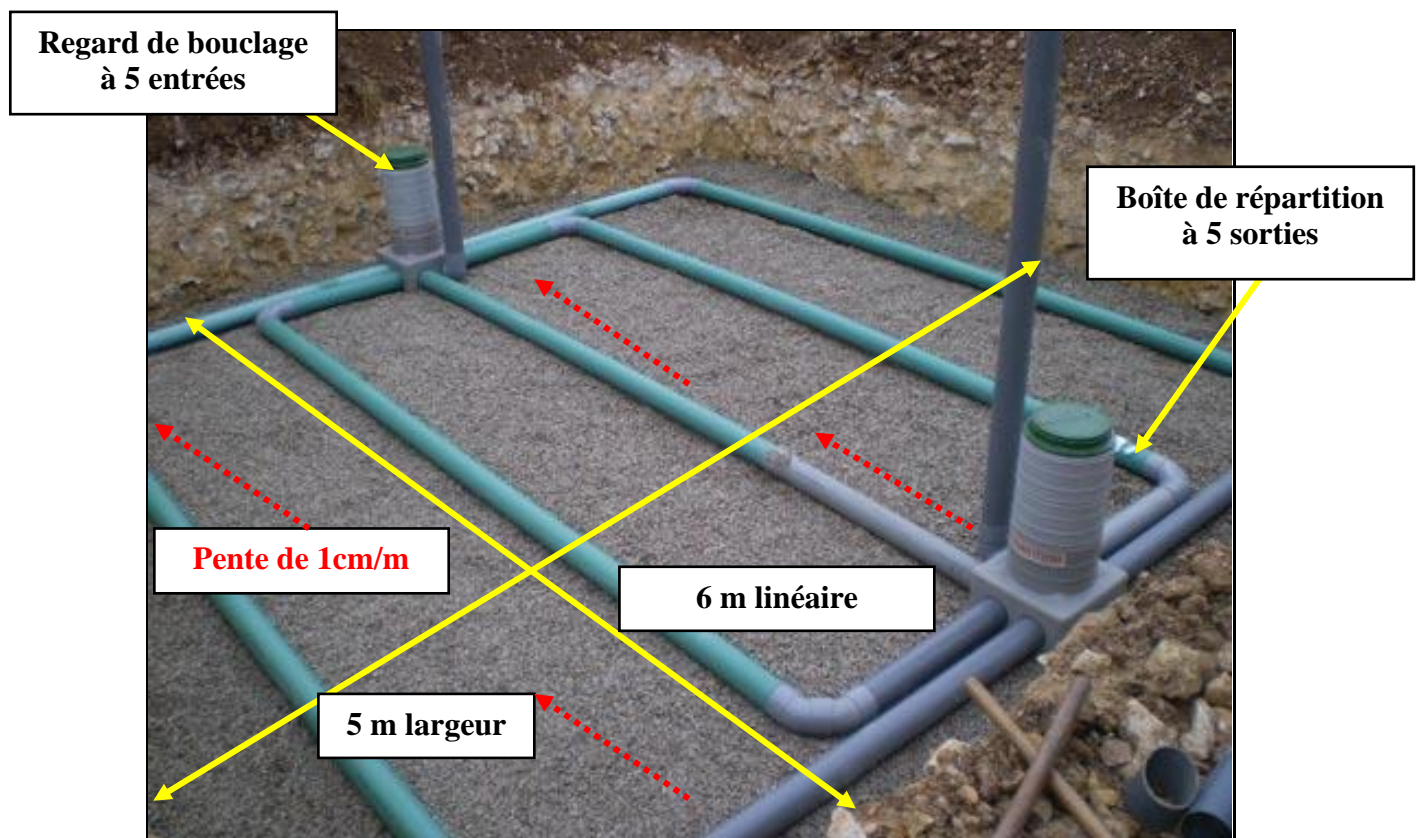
Exemple d'un lit d'épandage et disposition de 5 drains sur le lit de gravier
